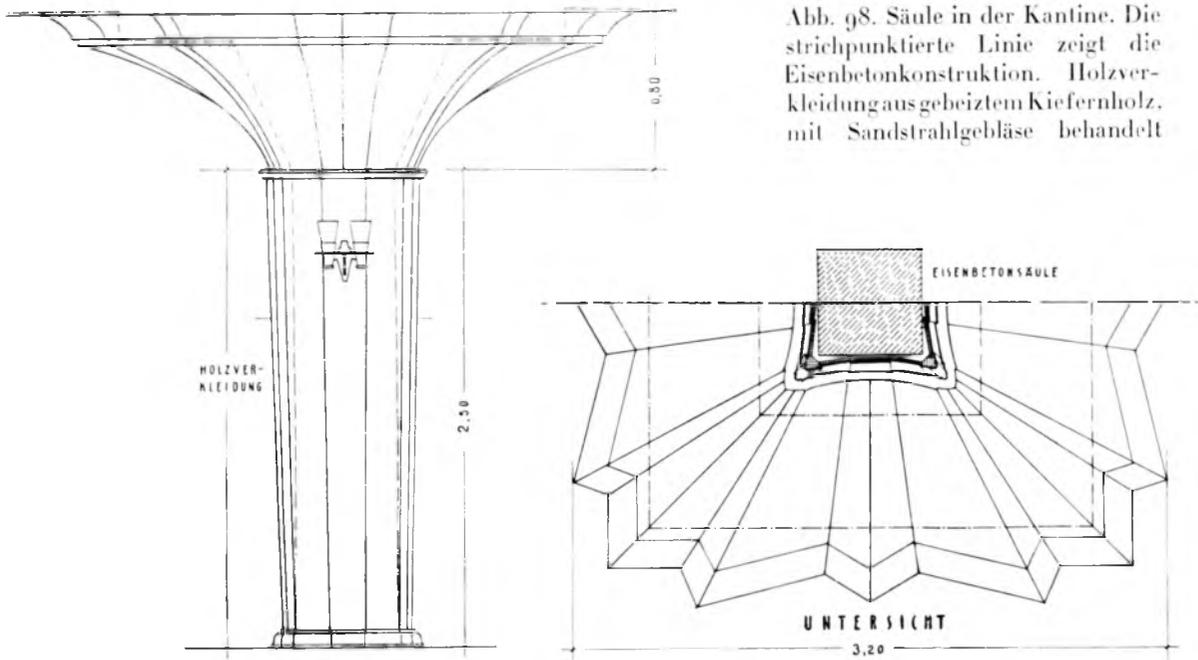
Säule in der Kantine. Die strichpunktigte Linie zeigt die Eisenbetonkonstruktion. Holzverkleidung aus gebeiztem Kiefernholz, mit Sandstrahlgebläse behandelt
